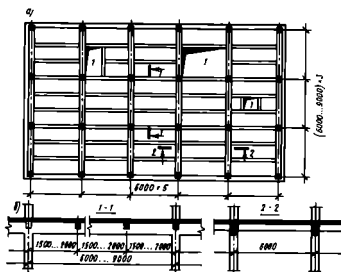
Монолитное ребристое железобетонное перекрытие:
